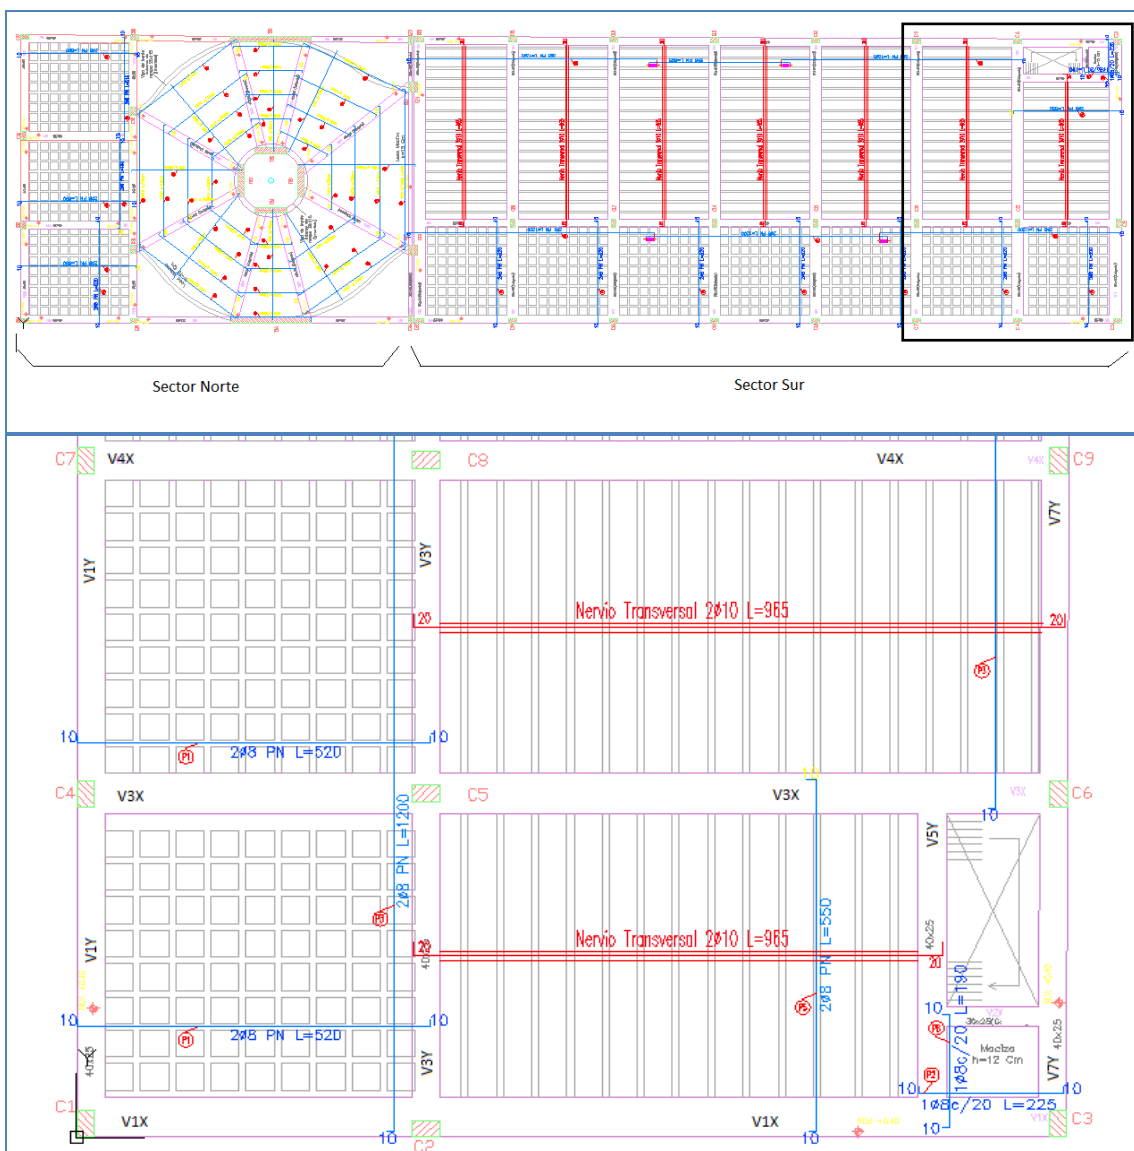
Planta de estructuras correspondiente a la Planta XXX del edificio de cocheras.
